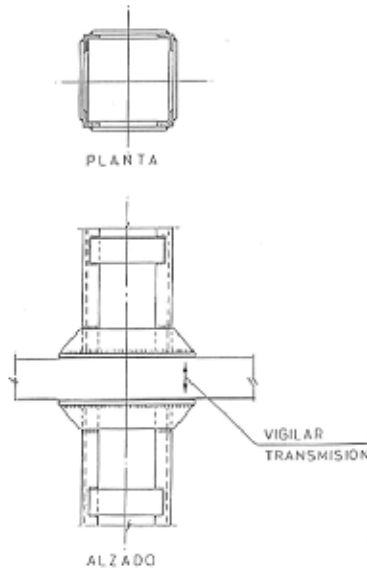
Refuerzos metálicos en pilares (Fuente: González y Díaz, 2000)
